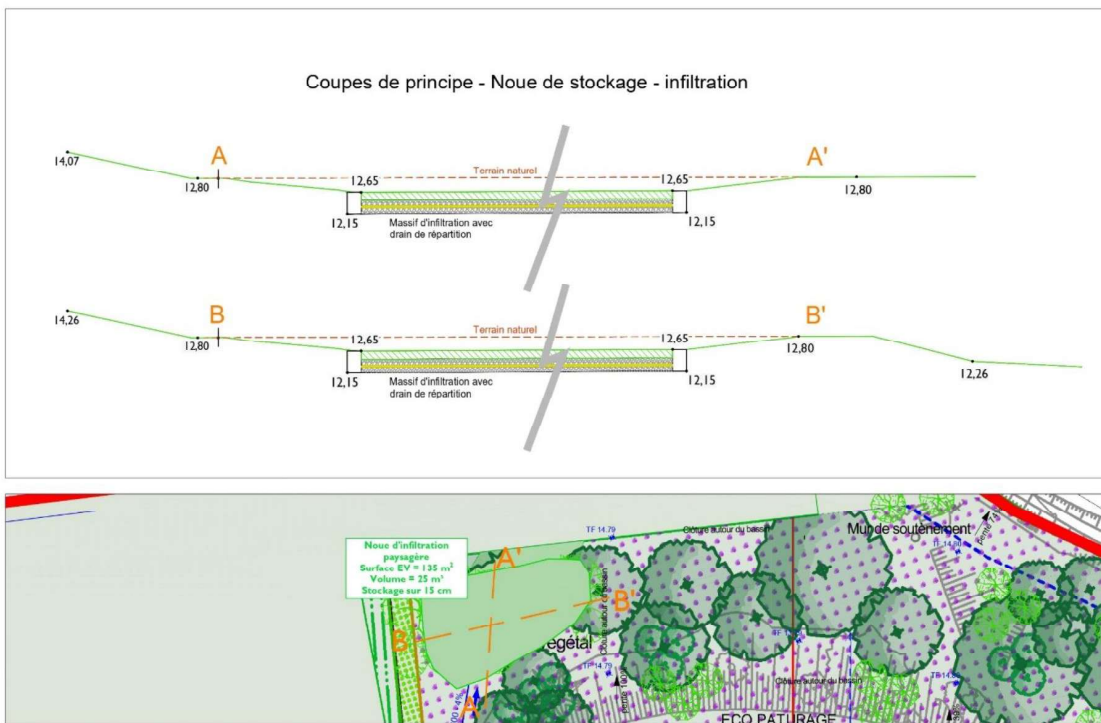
Plan des coupes longitudinales de la noue d'infiltration
